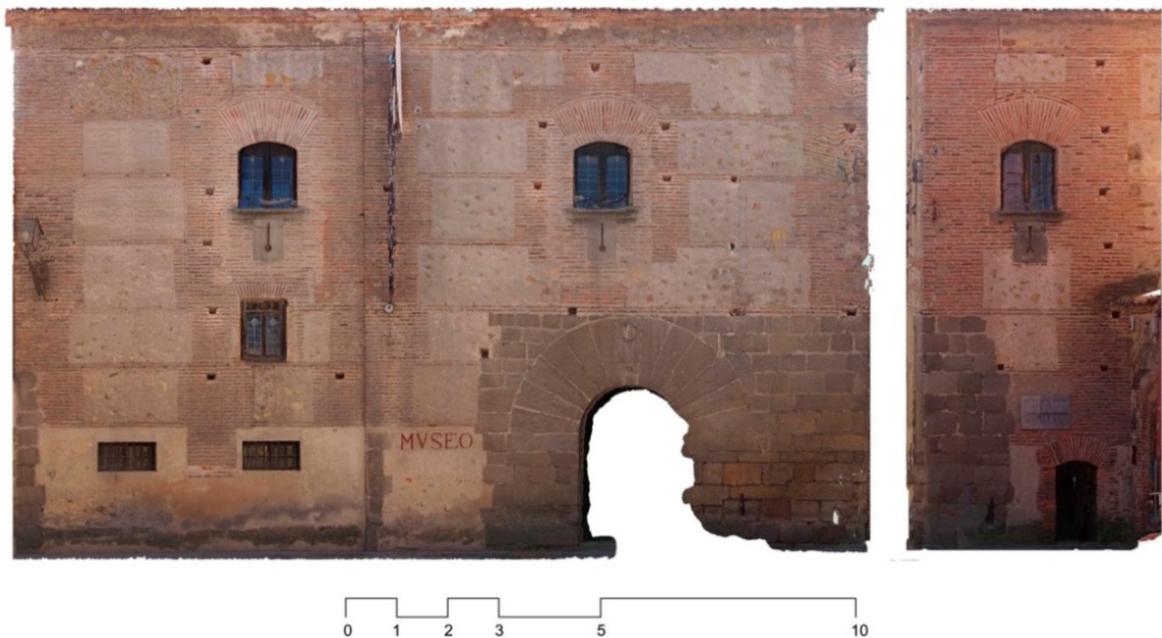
Fotoalzado del museo Rodera Robles. Alzado principal y alzado lateral. Segovia.
